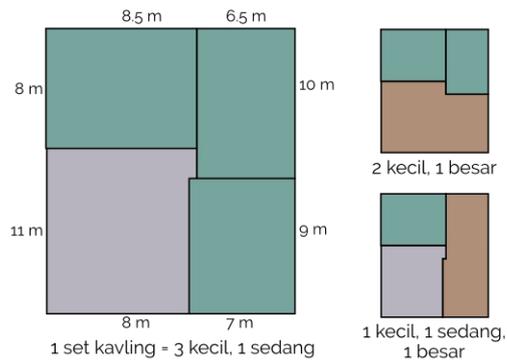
Block Plan Tipe Rumah (Alternatif 2)
